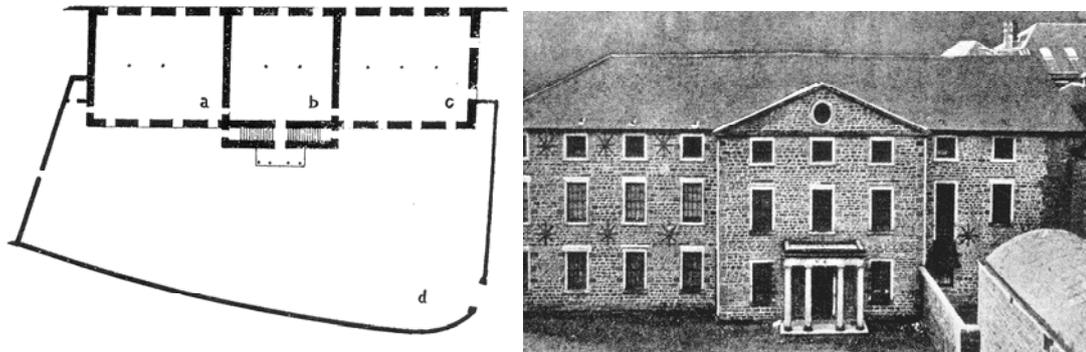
Das Neue Institut in New Lanark, Grundriss (l)
